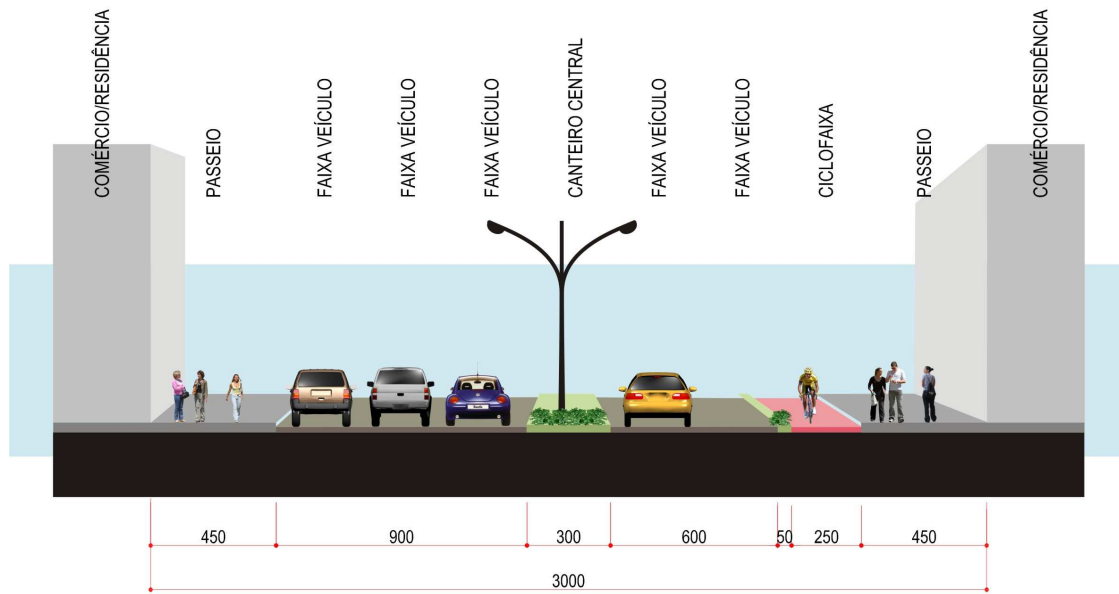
Perfil transversal da Av. Visconde de Guarapuava. Fonte: elaborado pela autora.
